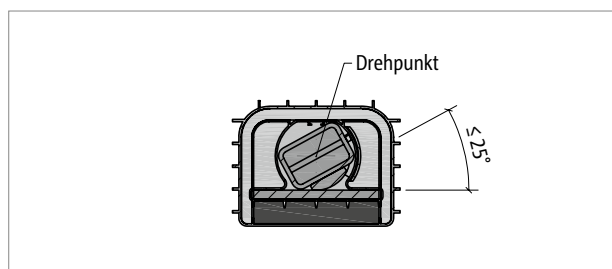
Tronsole® Q: Einbauvariante geneigter Einbau des Tragelements
